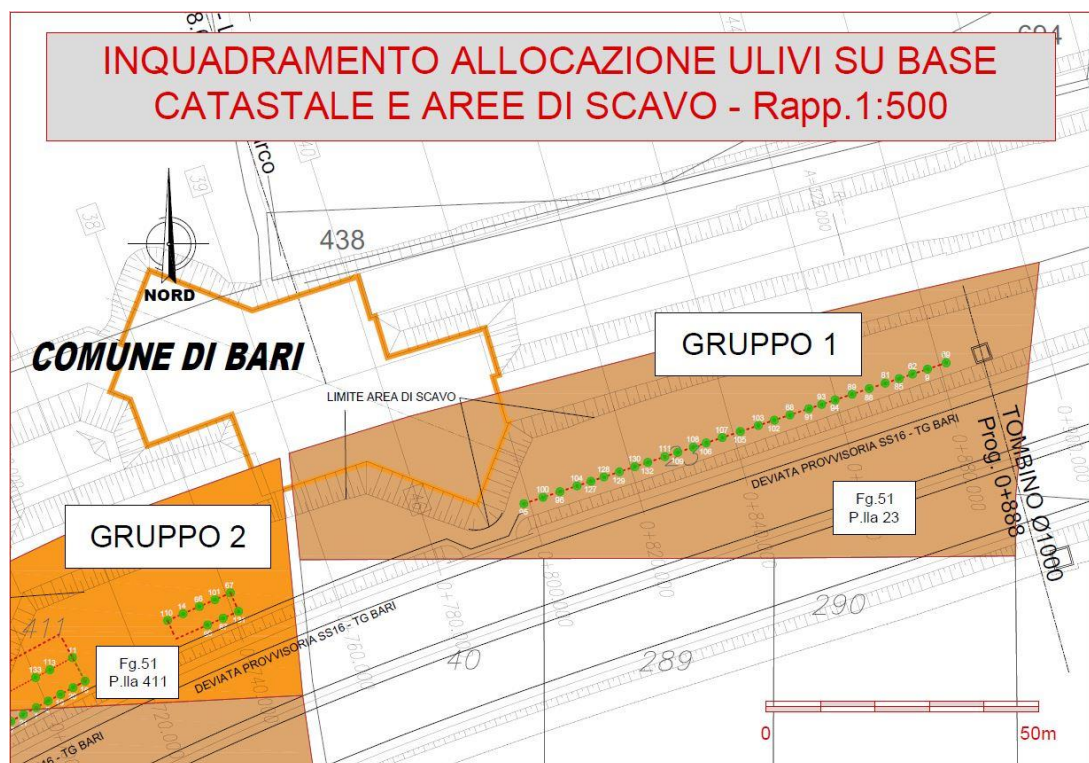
Planimetria attuale dei Gruppi 1 e 2
